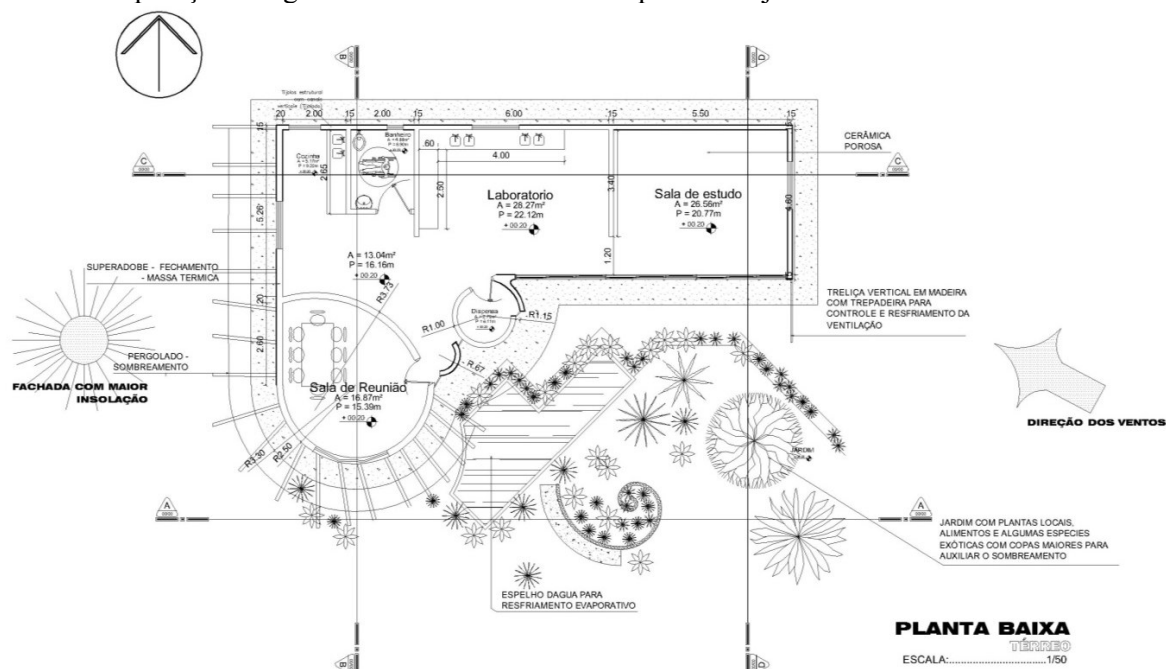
Planta Baixa – Anteprojeto do Laboratório do grupo de Pesquisa.
